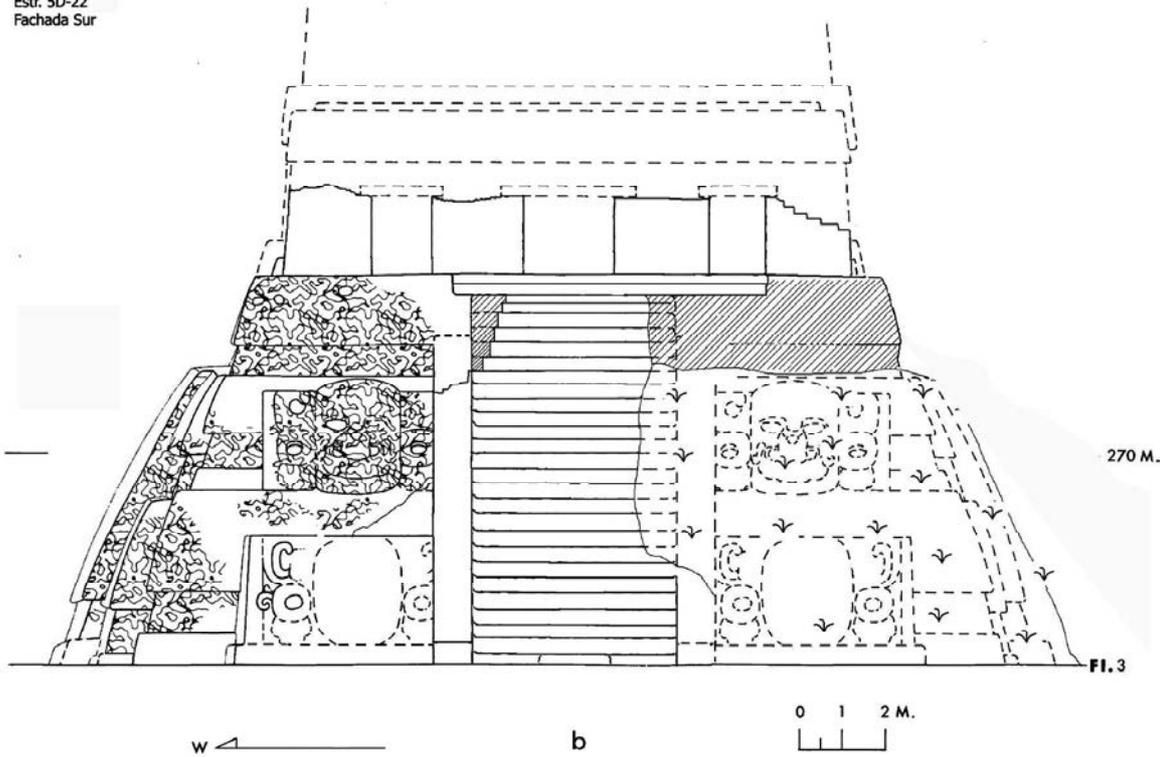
, Estr. 5D-22, Fachada Sur, deterioro profundo.
